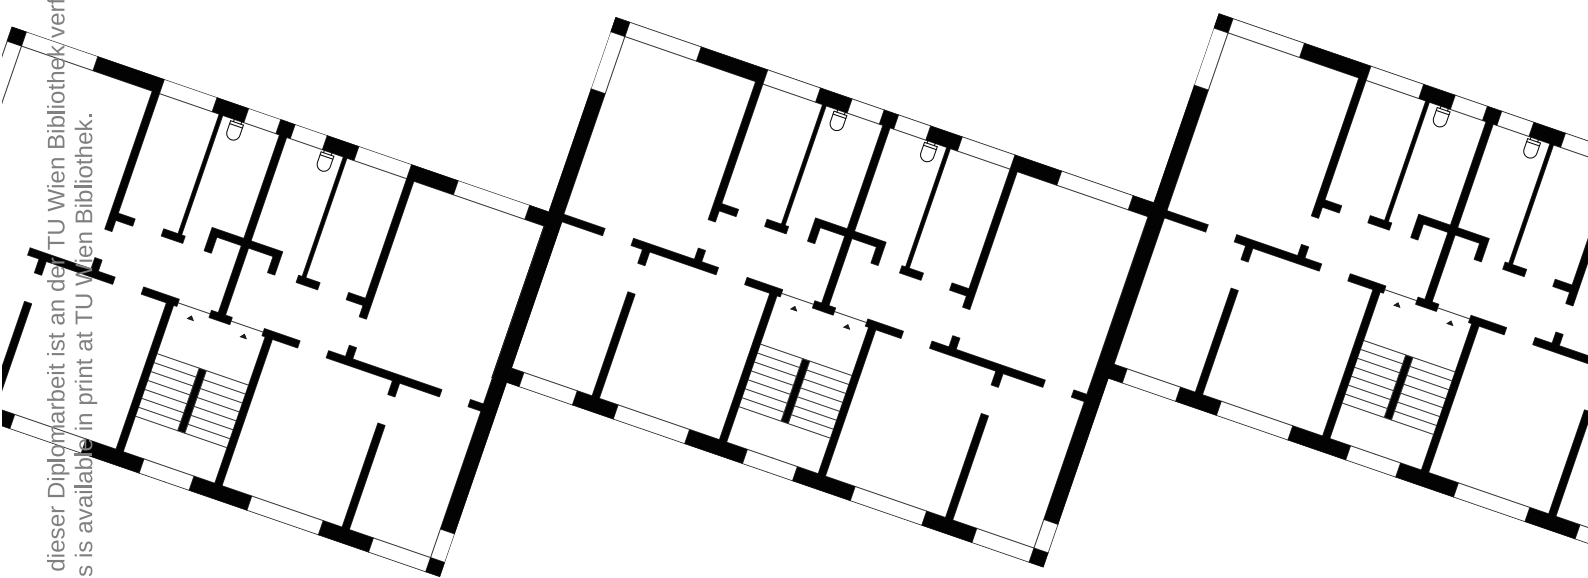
Plan, Siedlung Bruchfeldstraße - 1:200
